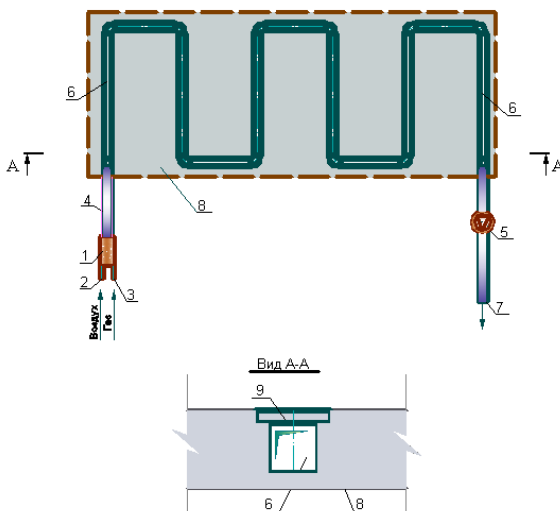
Трубчатый газовый нагреватель, размещенный в полу
